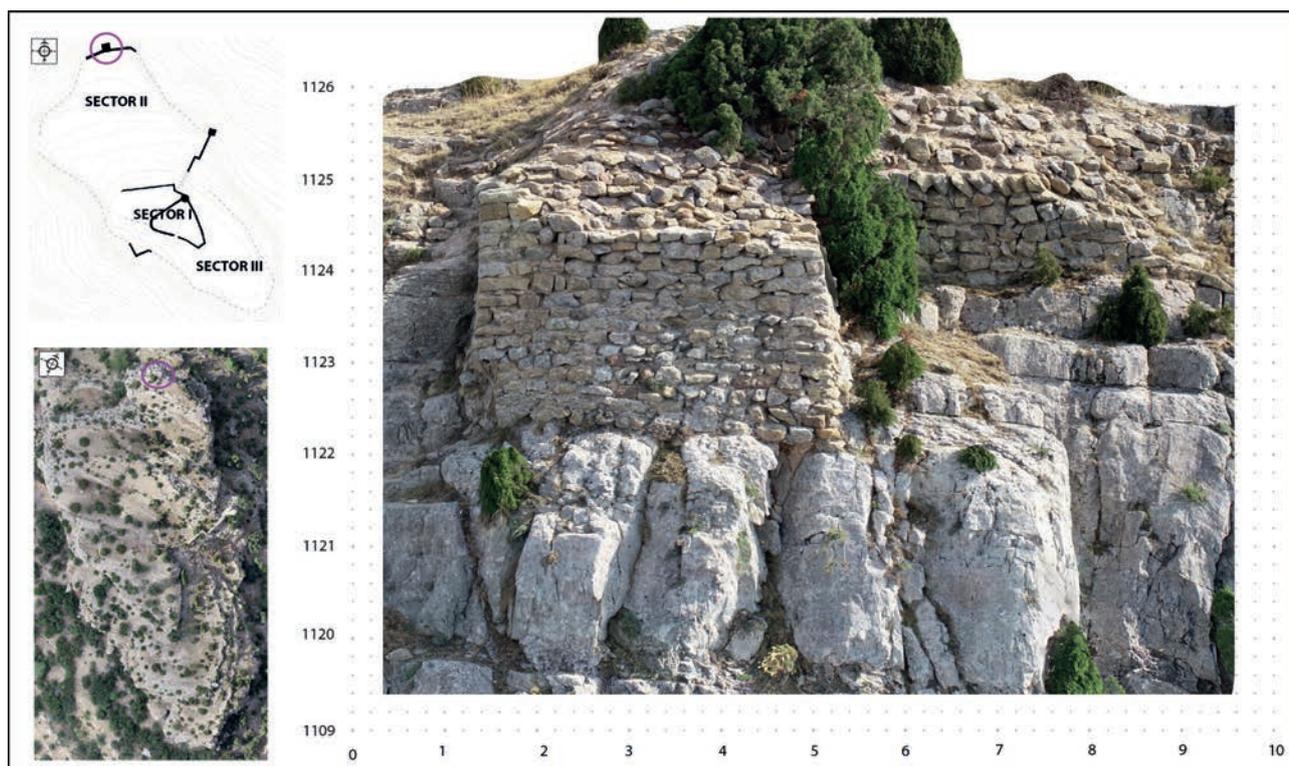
Sector II. Alzado fotogramétrico del segmento de muralla norte y de la Torre III.
